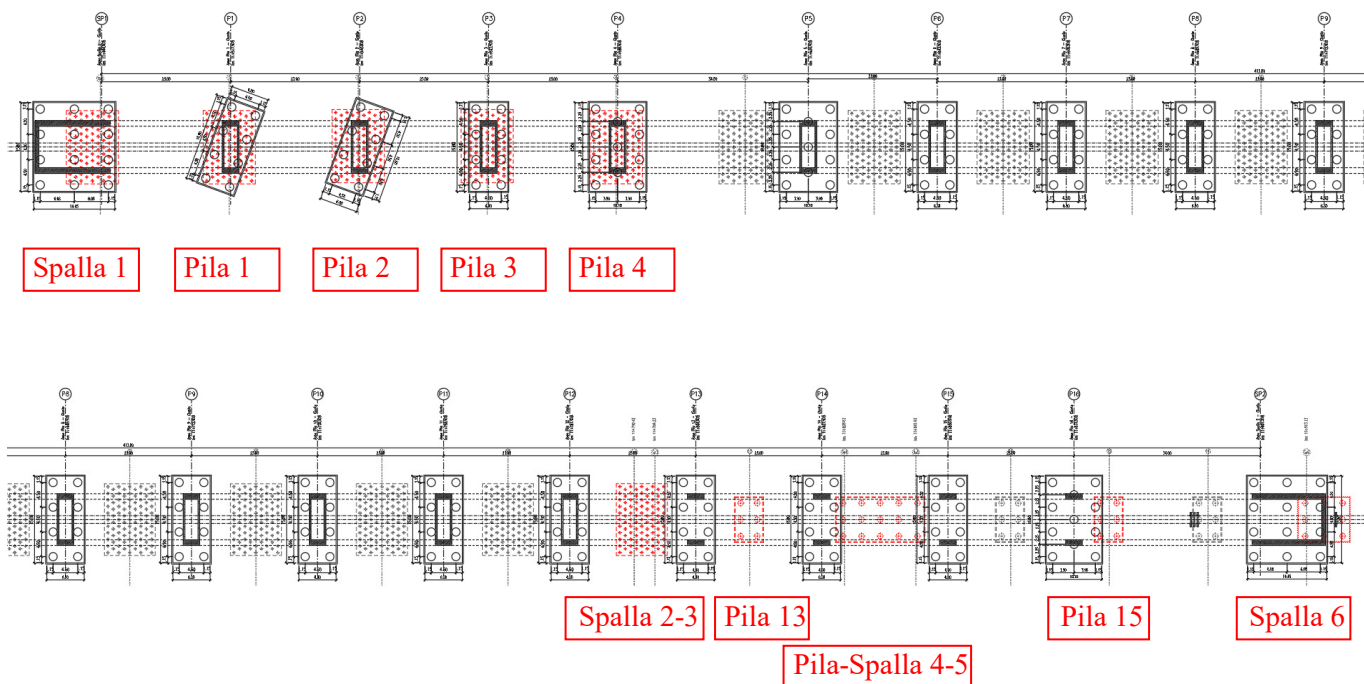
Vista planimetrica fondazioni esistenti interferenti
